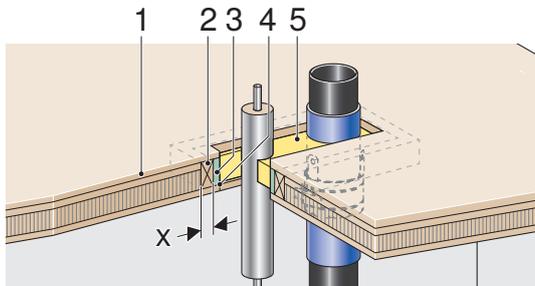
Ausführung des Deckendurchbruchs ohne Kragen bei Bauteilen mit brennbaren Oberflächen
